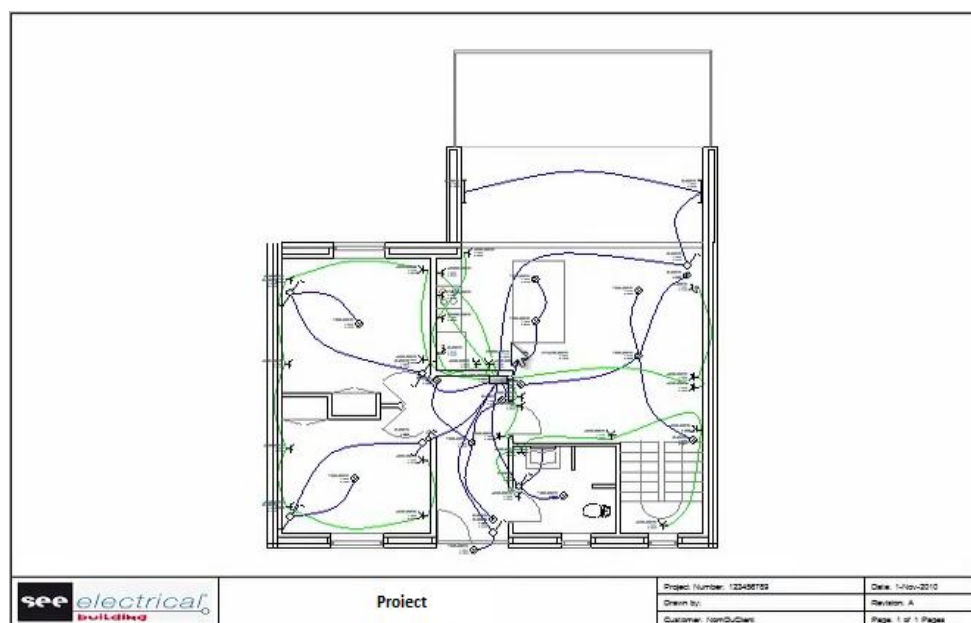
Planul camerelor în care se proiectează instalația electrică.
